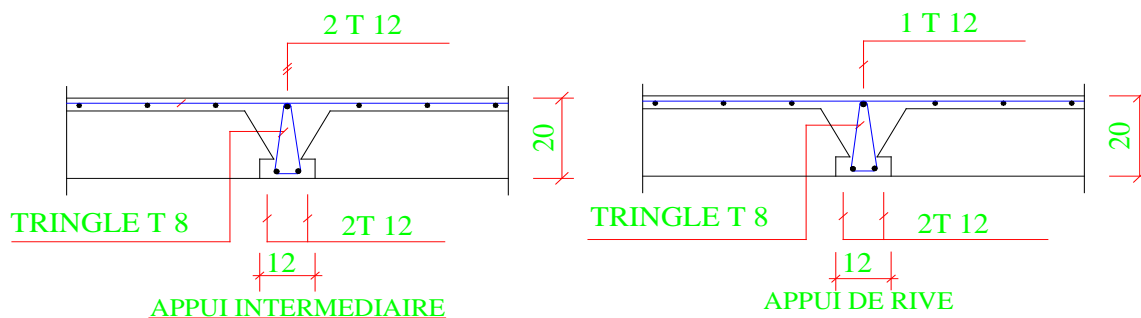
ferrailage coupe en travée./ Figure (IV.12) : ferrailage coupe en appuis.
